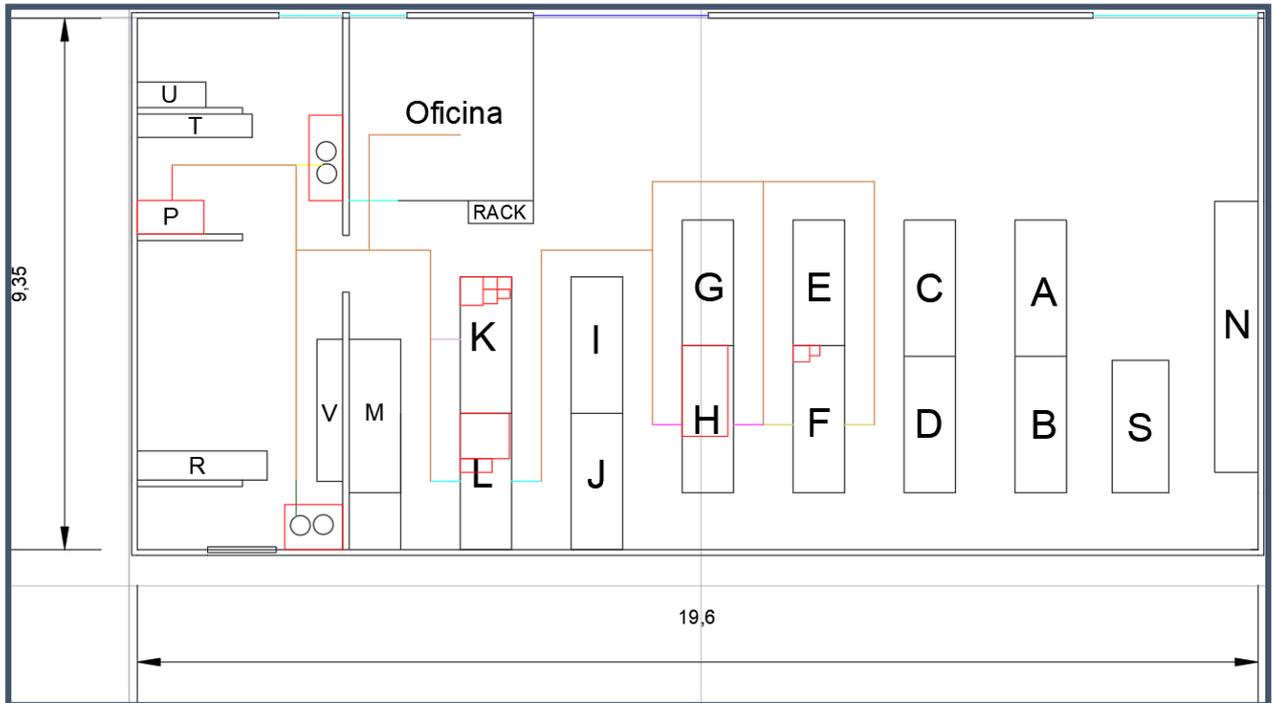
Plano con delimitación de espacio para repuestos
